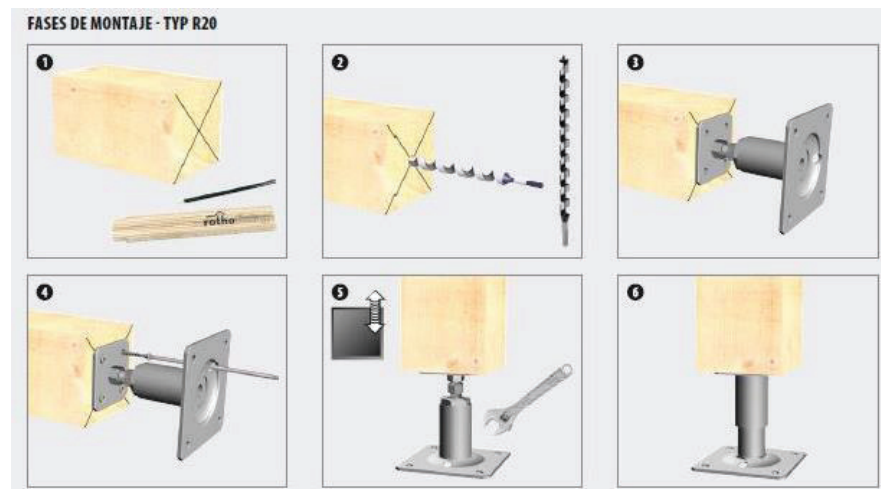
4 Proceso de Montaje de pie para pilar de madera.
